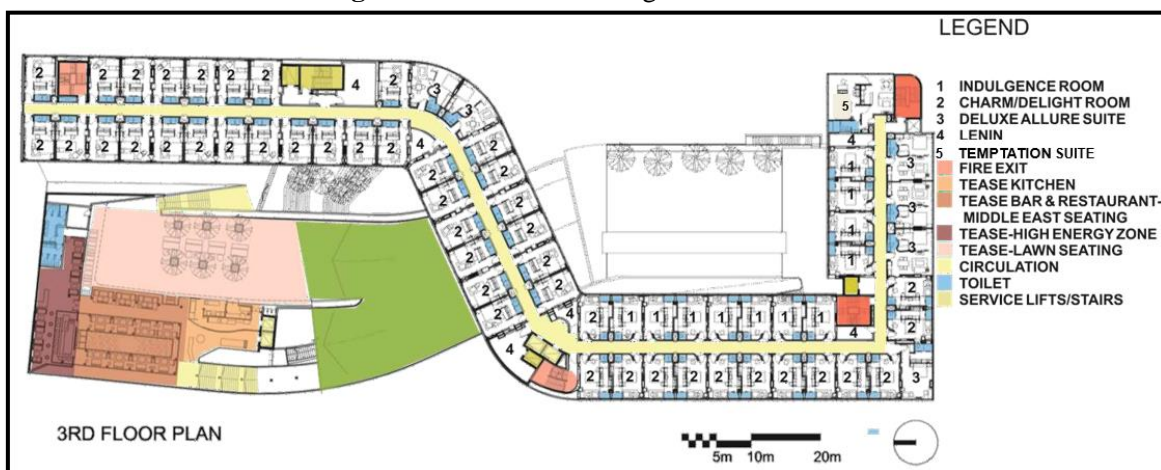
Plan du 3<sup>ème</sup> étage Hôtel Vivanta
